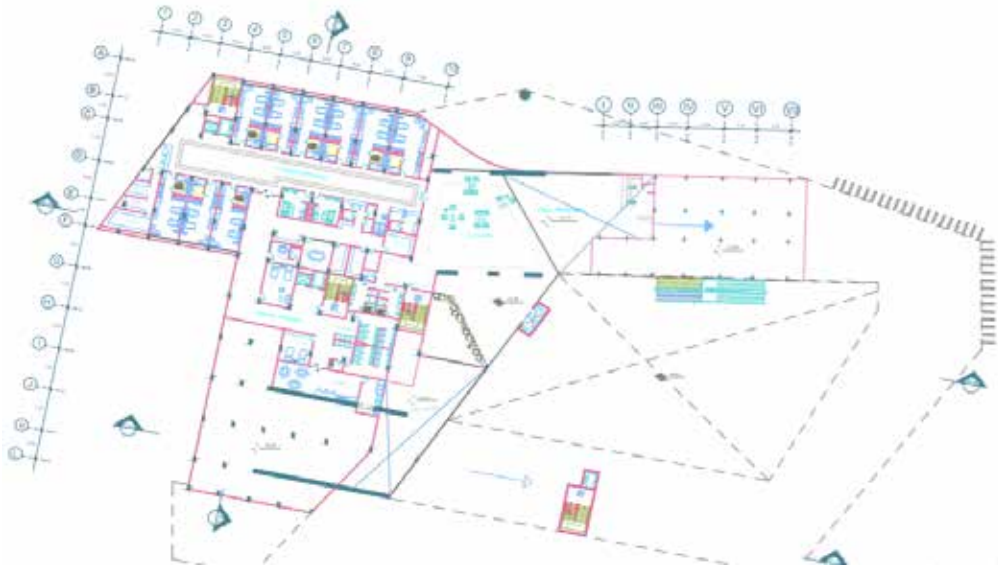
Planta Baja nivel +0,00m. (2018)
